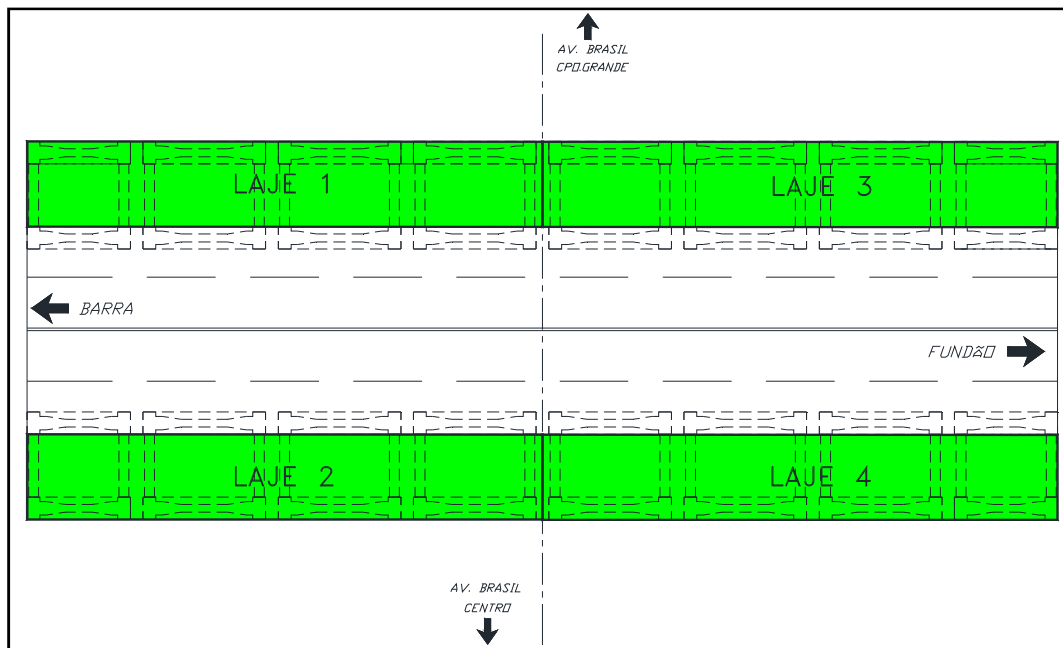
Esquema do posicionamento das lajes por concretagem de tabuleiro. Entre um tabuleiro e outro será executada junta *jeene
